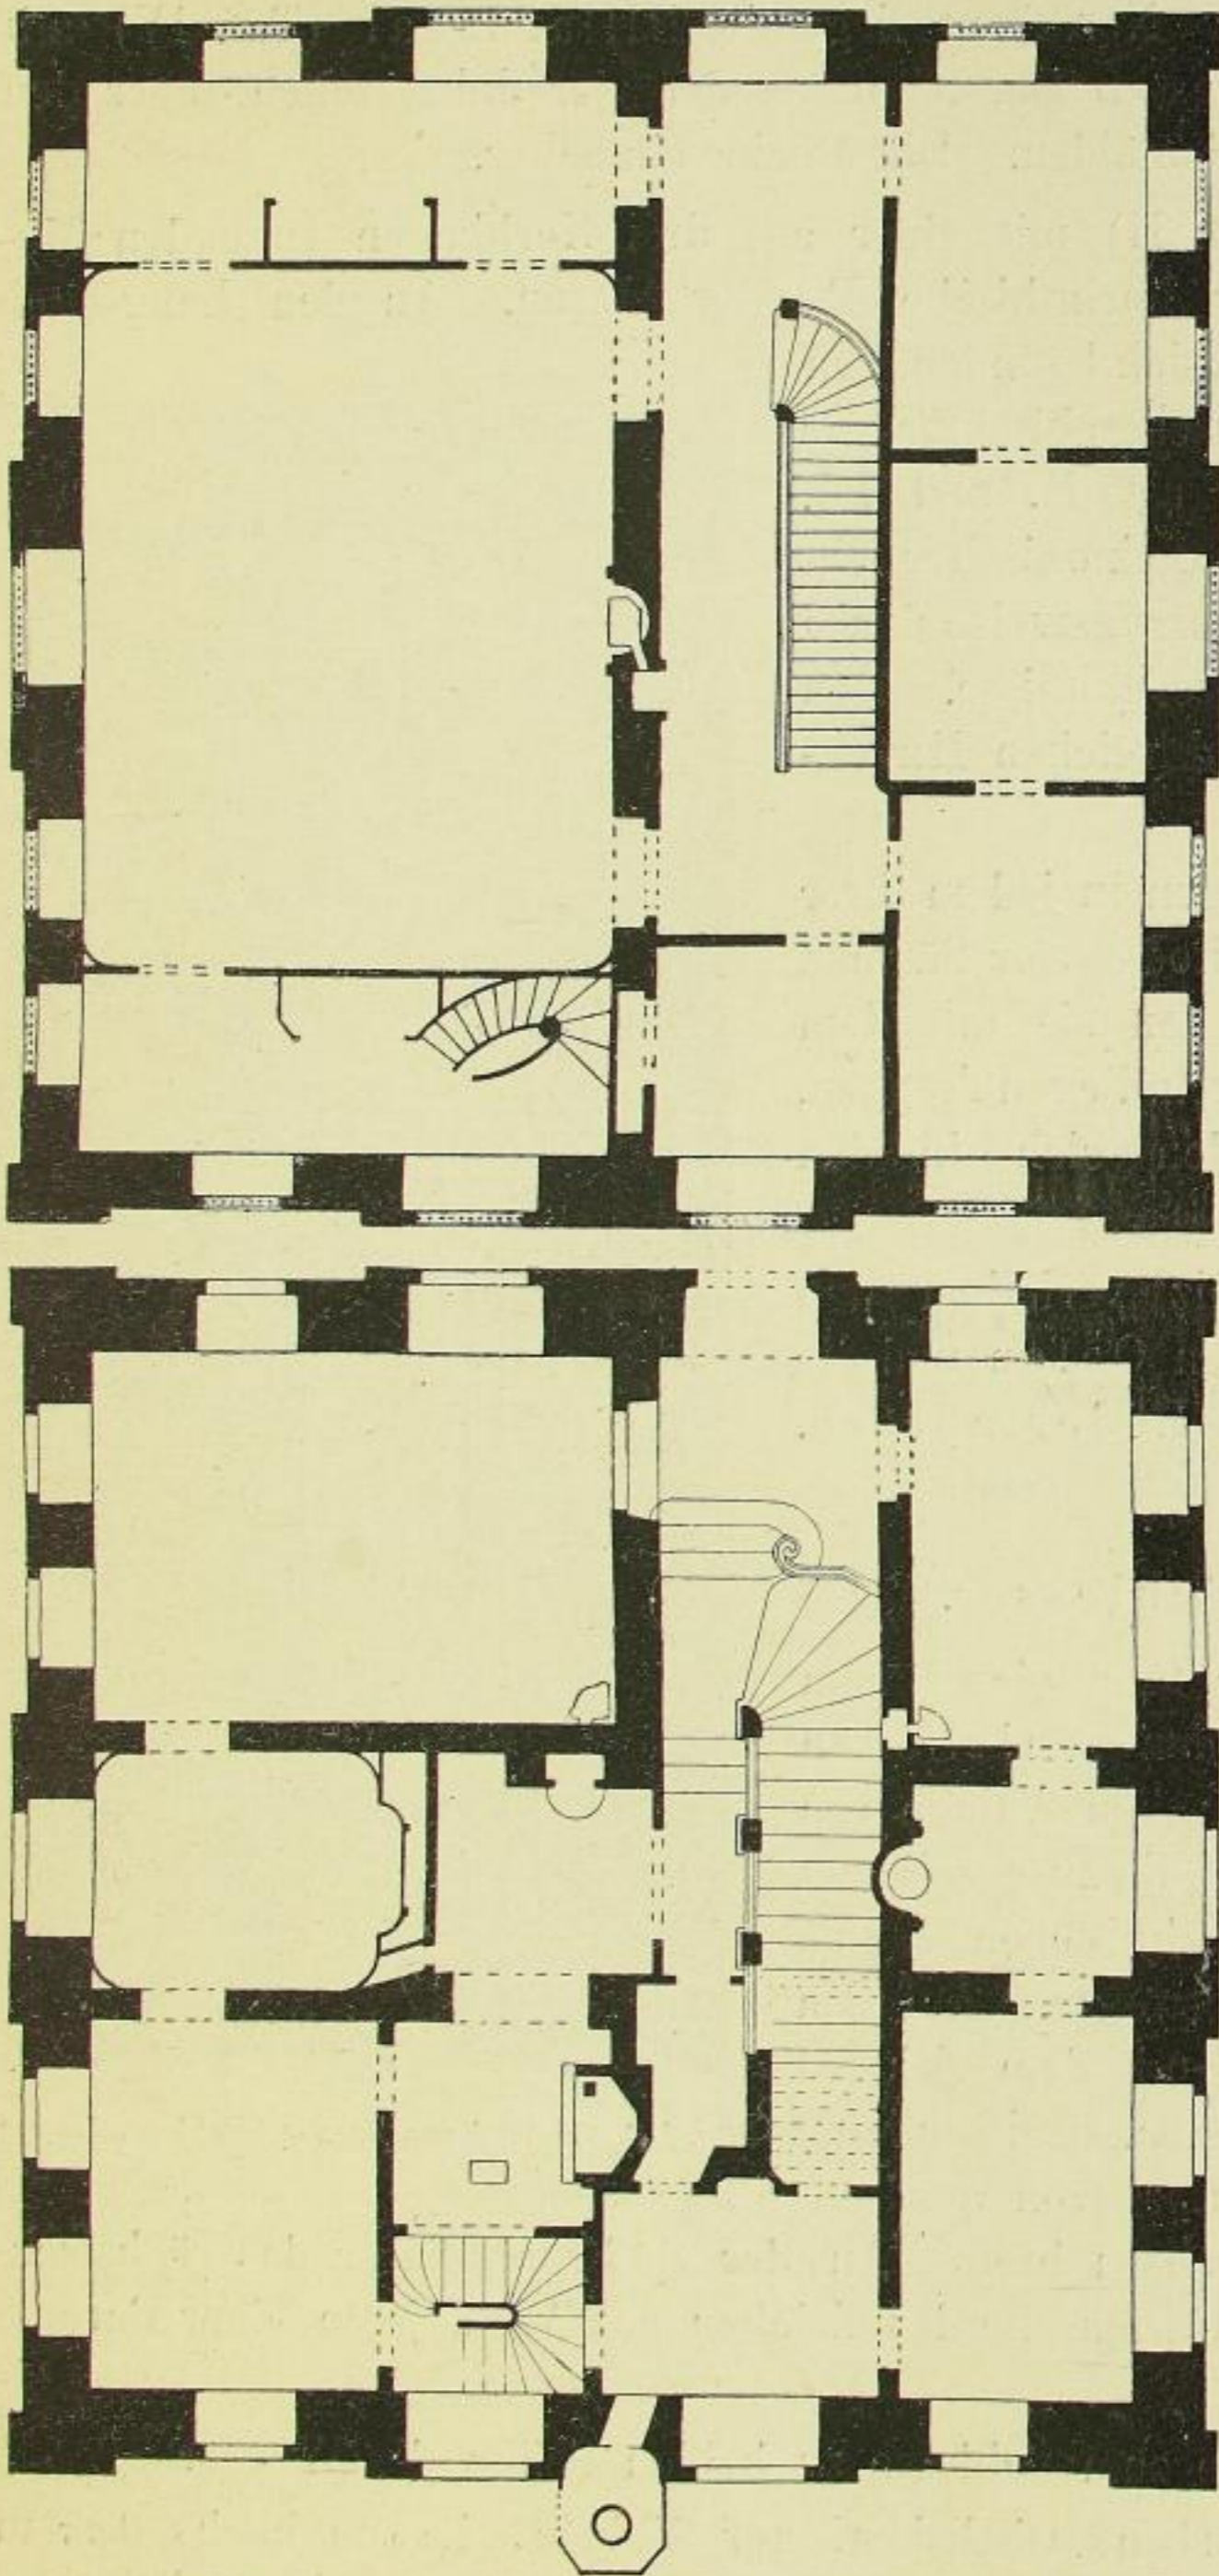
u. 112. Moritzburg, Fasanerieschloss, Grundriss des Erd- und ersten Obergeschosses.
